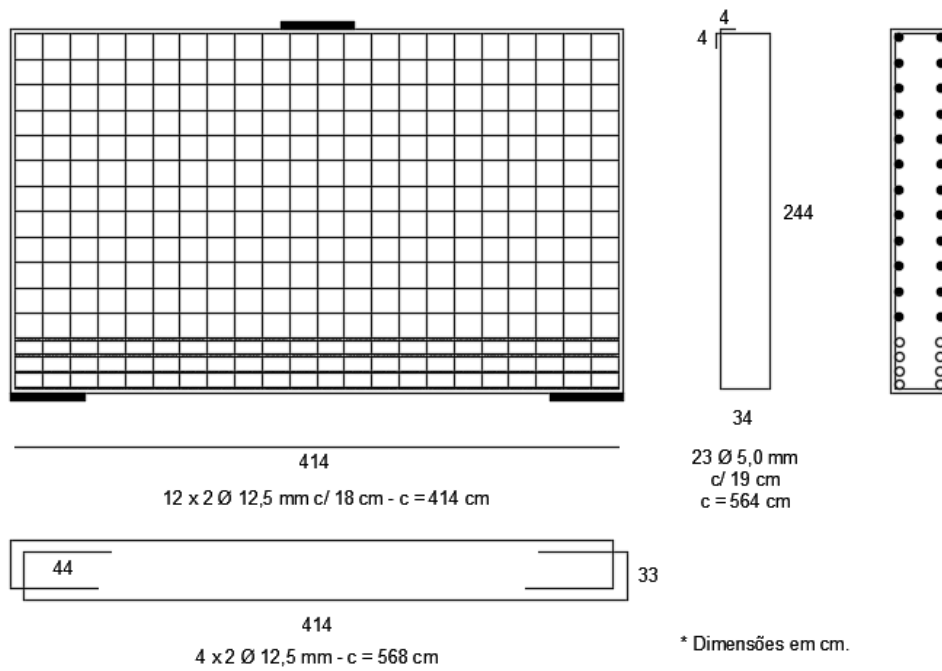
Detalhamento da armadura do modelo de viga-parede B, obtido com dimensionamento segundo ABNT (2014)
